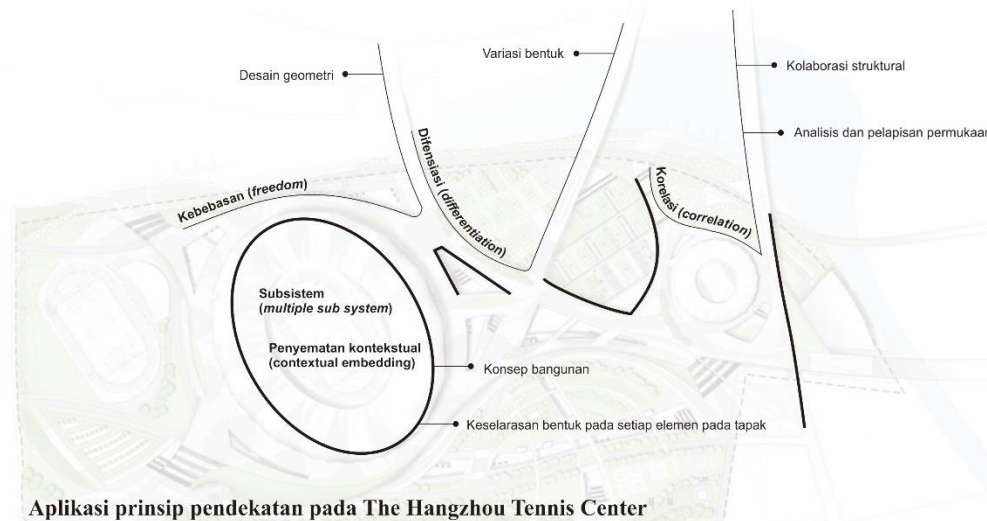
18 Siteplan The Hangzhou Olympic Sports Center
